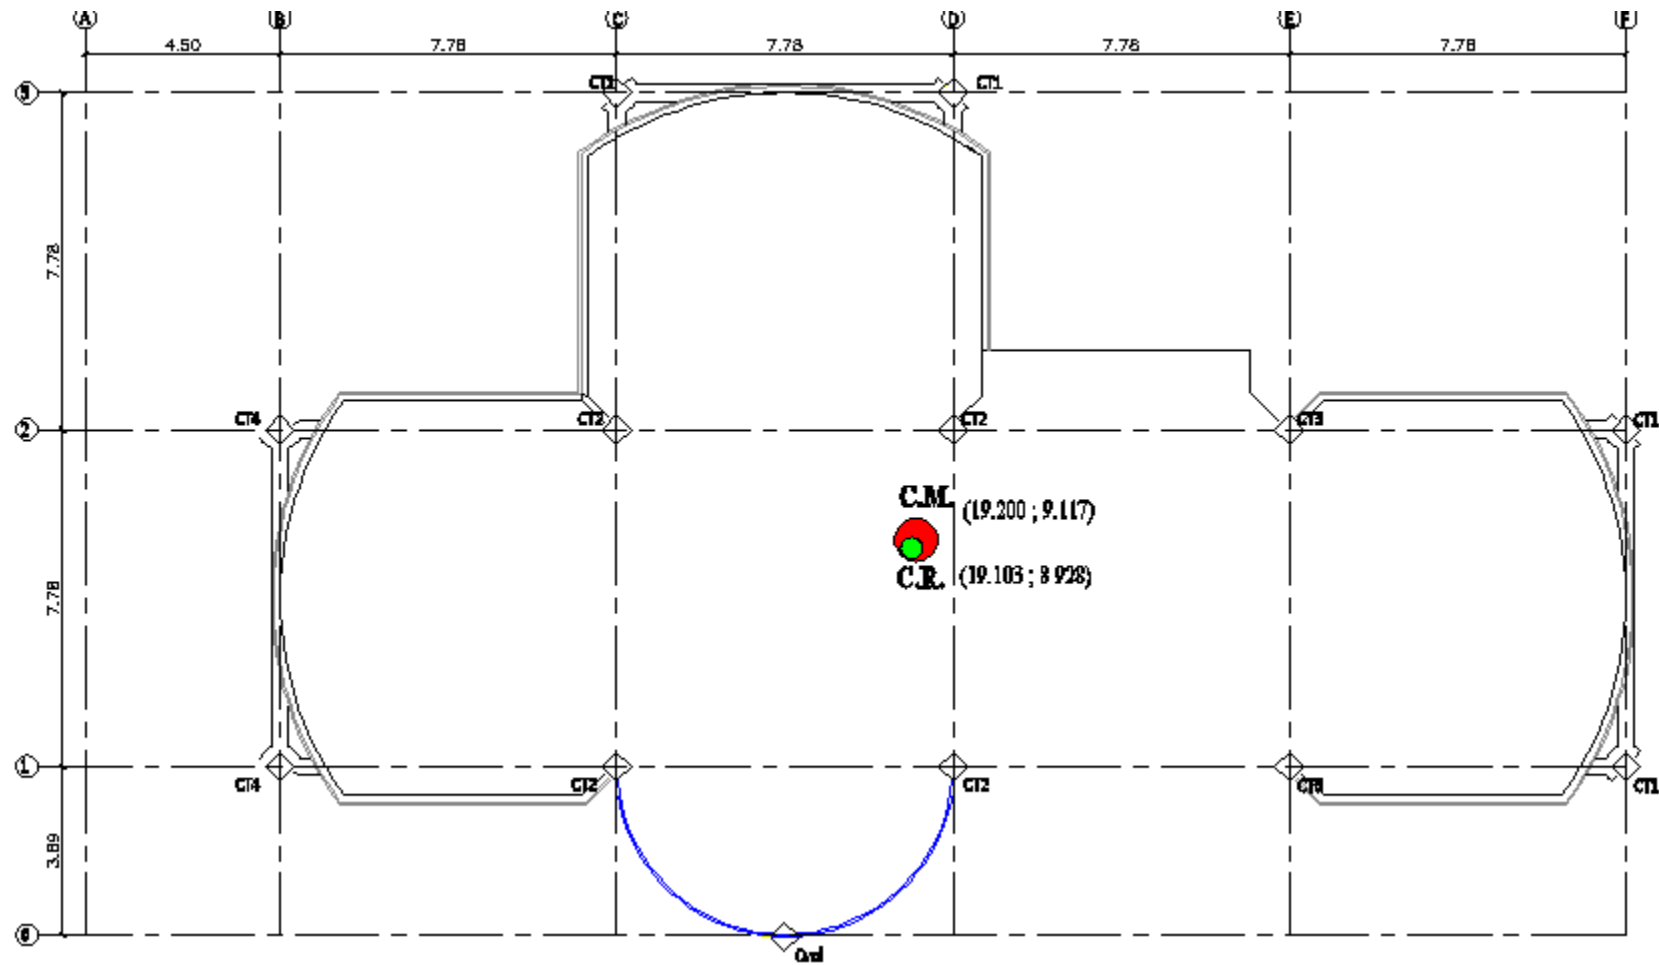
Centro de Masas y Rigidez de las Losas N+5.96, N+8.84
